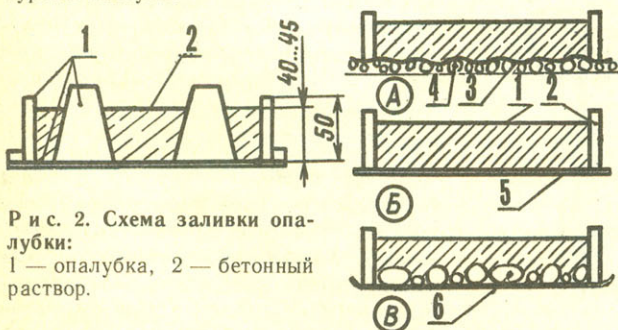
Схема заливки опалубки: 1 — опалубка, 2 — бетонный раствор.
